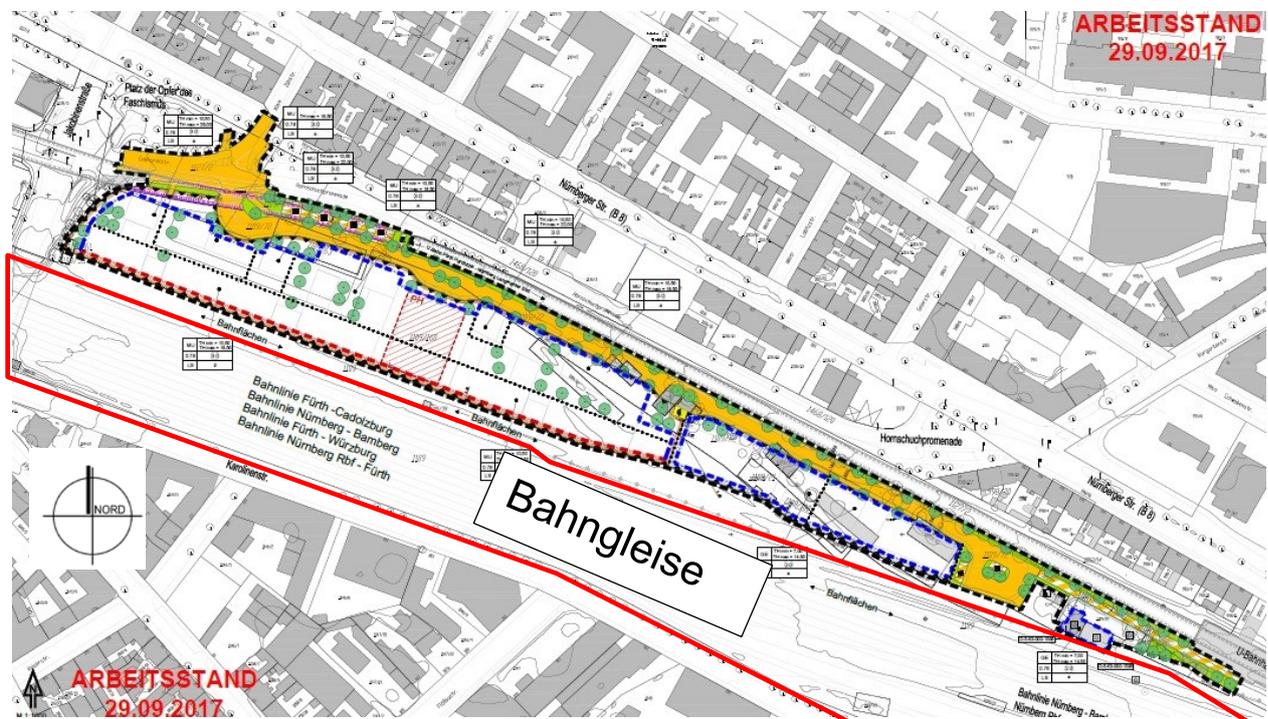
Lageplan mit Bahngleisen und geplanter Bebauung
